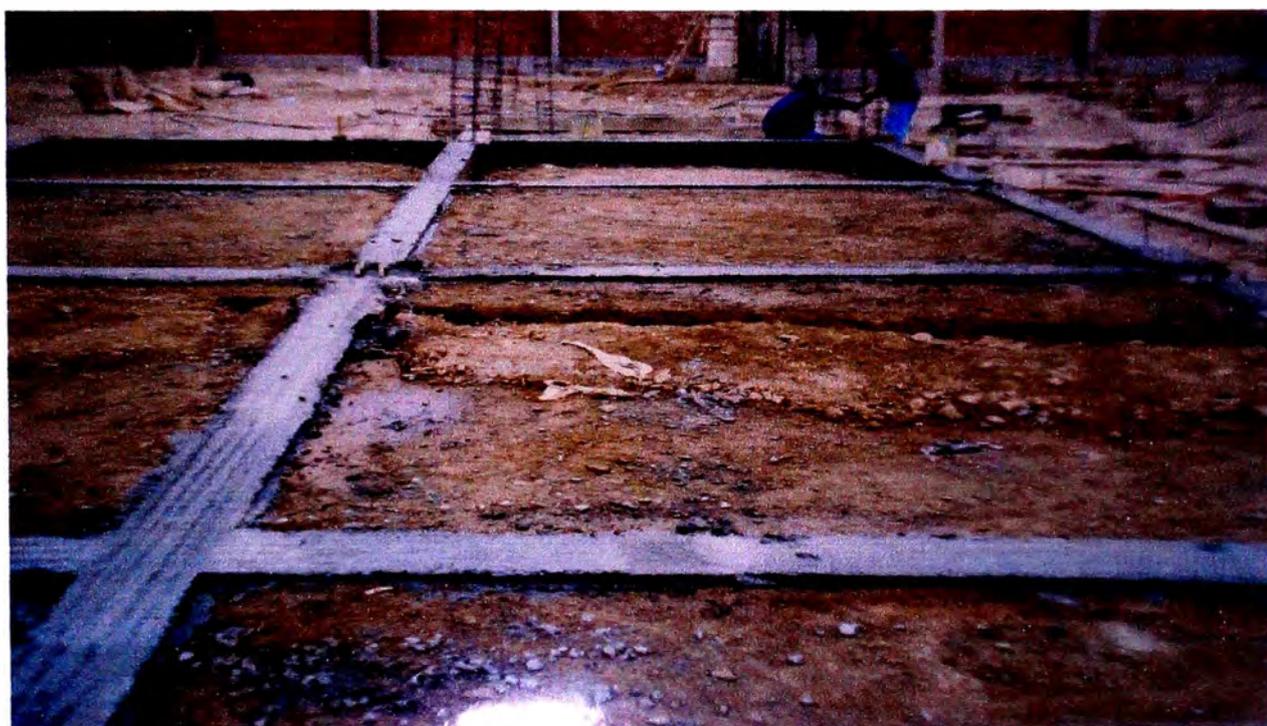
RELLENO COMPACTADO PARA FALSO PISO ARMADO
